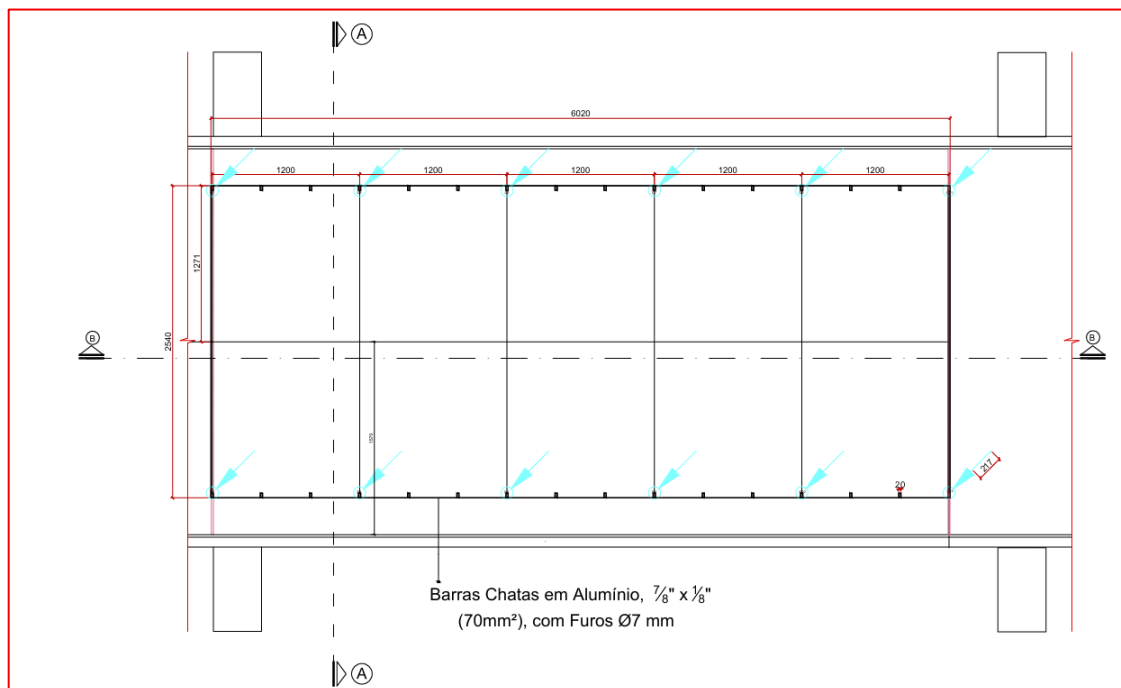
Planta baixa indicando as descidas do SPDA. Fonte: Projeto.
